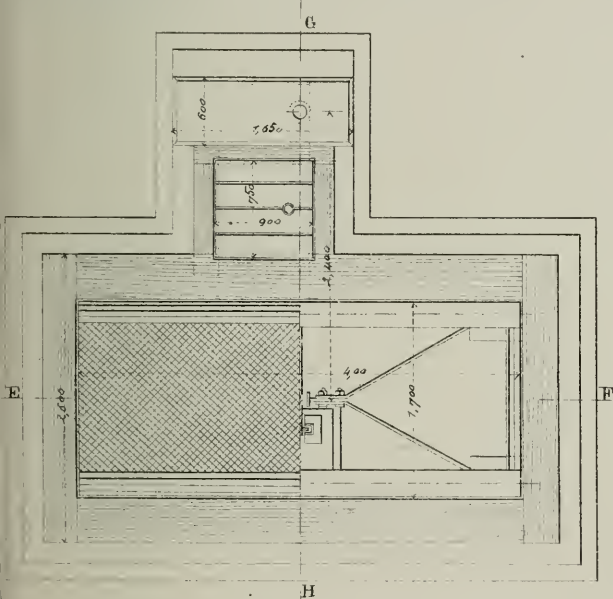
Elevation d'un levier rectangulaire & de l'appareil protecteur à 0,025 p^r 1^m
